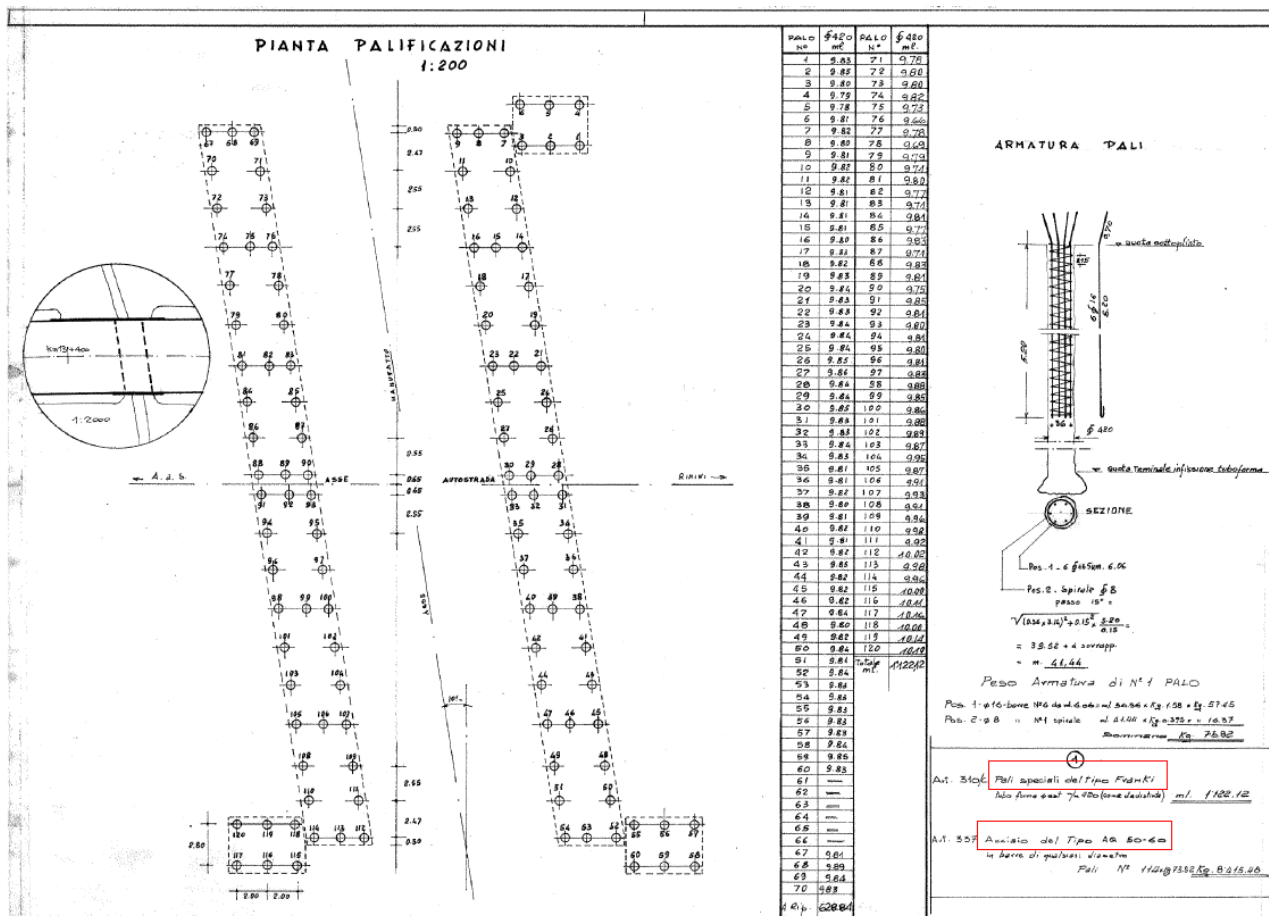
Struttura originaria – Pali tipo FRANKI sotto fondazione spalla
